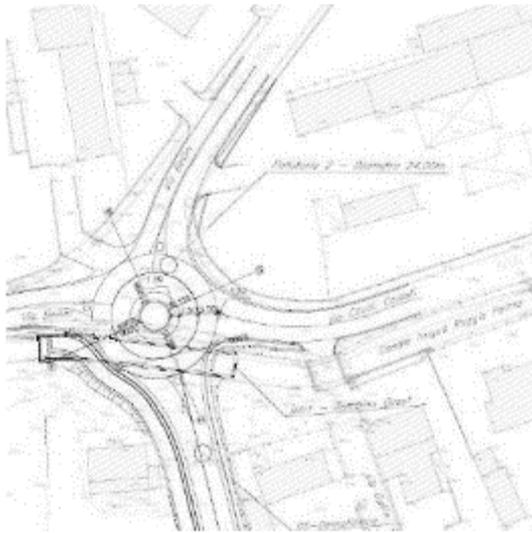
Progetto Definitivo - Dettaglio della rotonda di collegamento fra Via Casali Caiselli e Via V. Bellini
